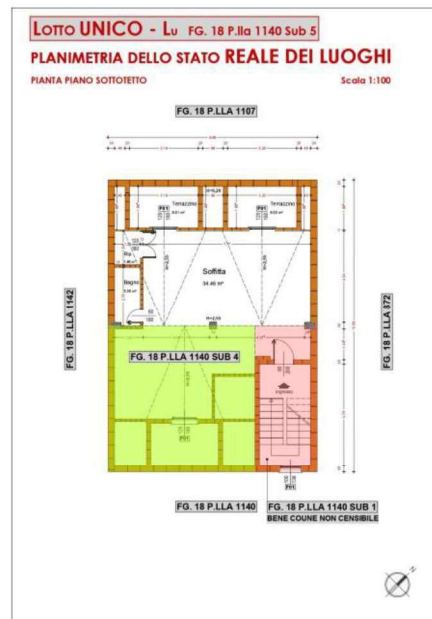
Planimetria dello STATO REALE LOTTO LU PIANO SOTTOTETTO (ALL. 07).
